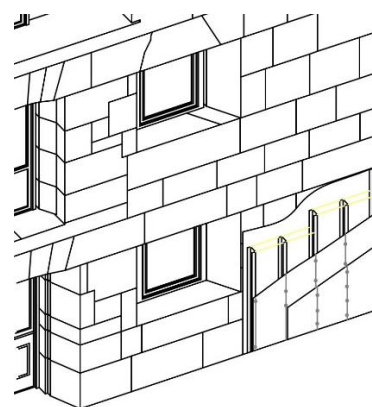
Dibujo de la colocación de trasdosado en el muro de piedra.
